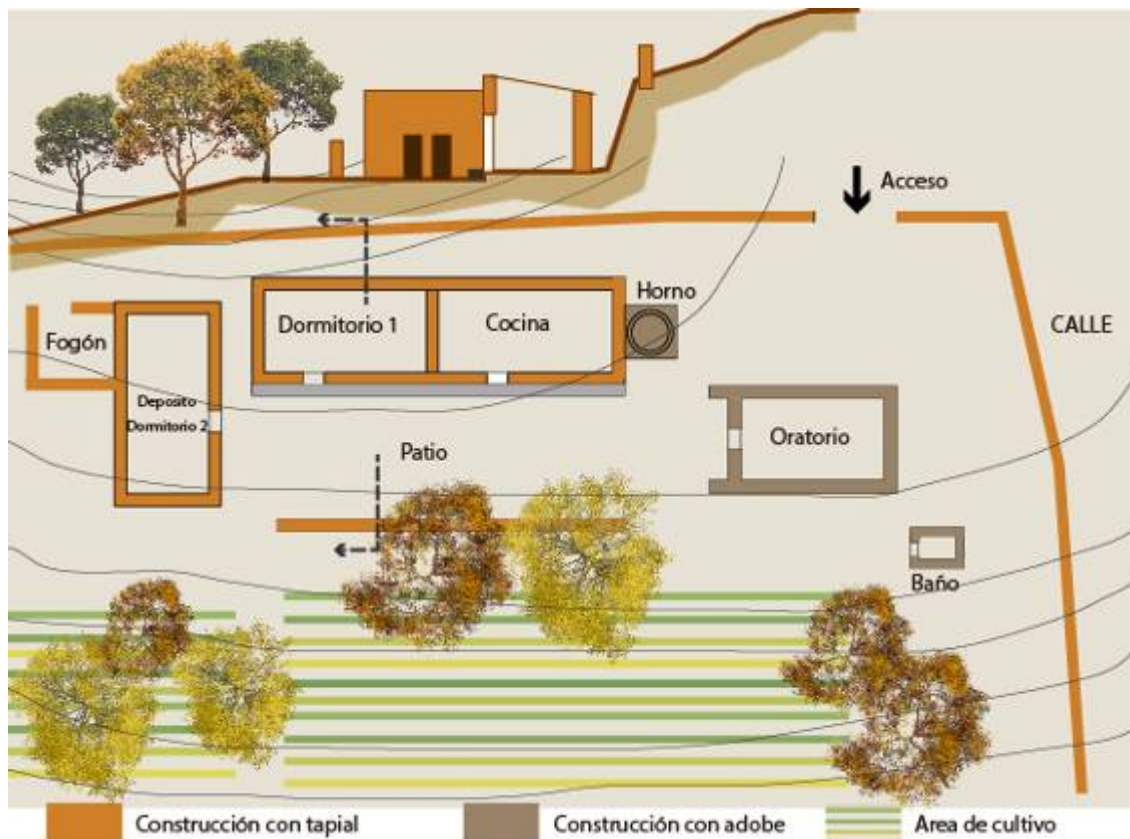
Planimetría de casa P. Ubicación localidad de Poscaya.
